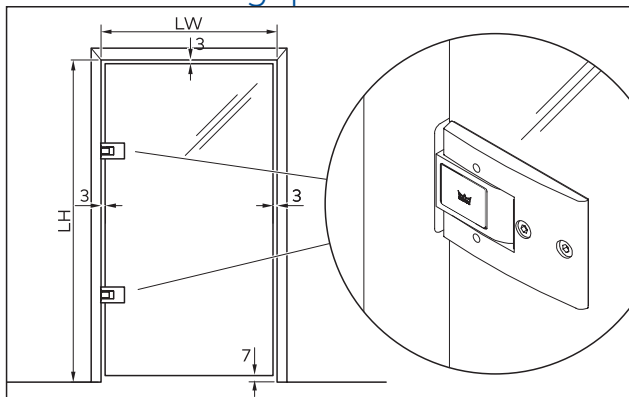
Spaltmaße für Zargenbefestigung mit einglassener Montageplatte
